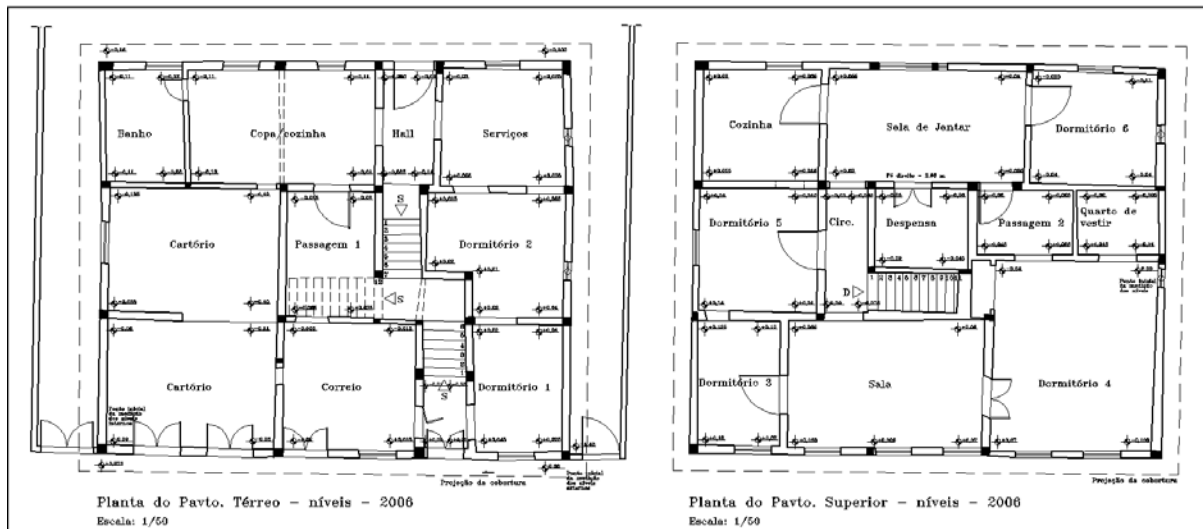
Levantamento da planta e do nivelamento do Sobrado do Cartório, realizado em 2006/7 (Fonte: Peixoto, 2007)
